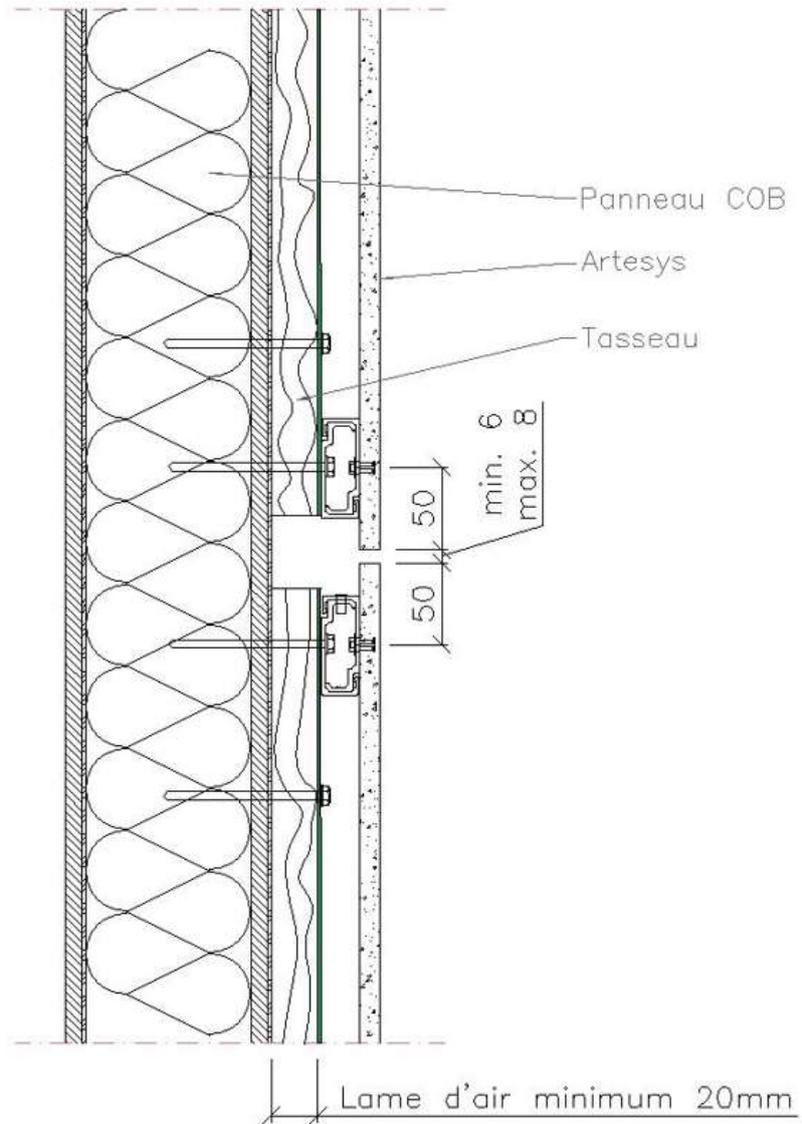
Pose sur COB - Joint vertical (coupe horizontale)
